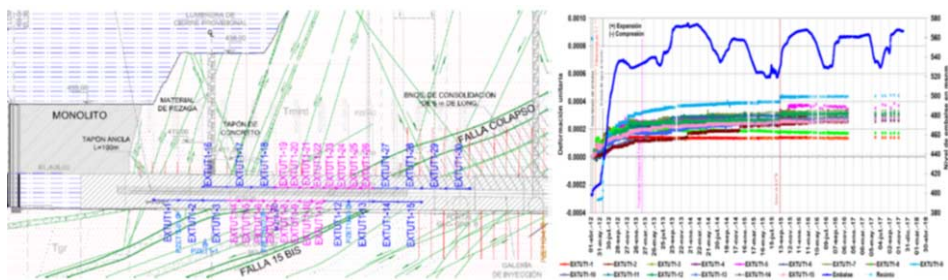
Instrumentación instalada en los túneles ancla o taponos estructurales de presa La Yesca. Figura cortesía de la CFE, GEIC.
